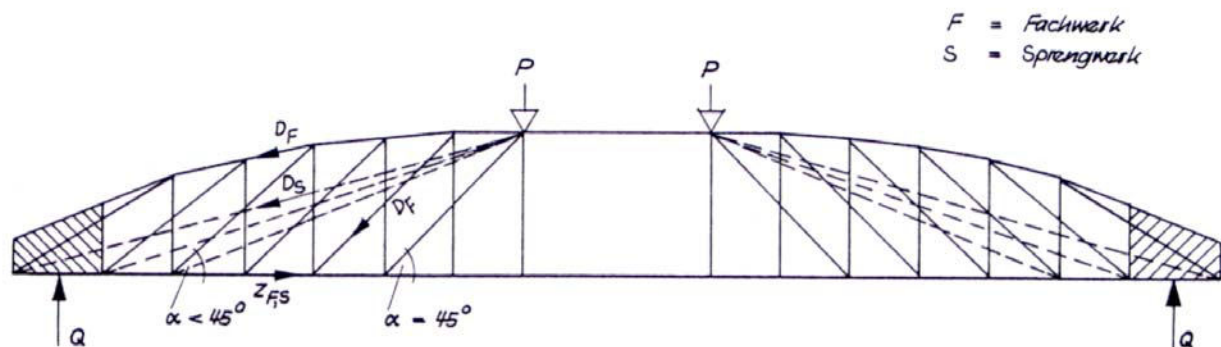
Tragmodell für querkräftbewehrtes Porenbeton. Fachwerk mit geneigtem Obergurt und veränderlichen Druckstrebenneigungen überlagert mit einem Sprengwerk nach [brie_1]
